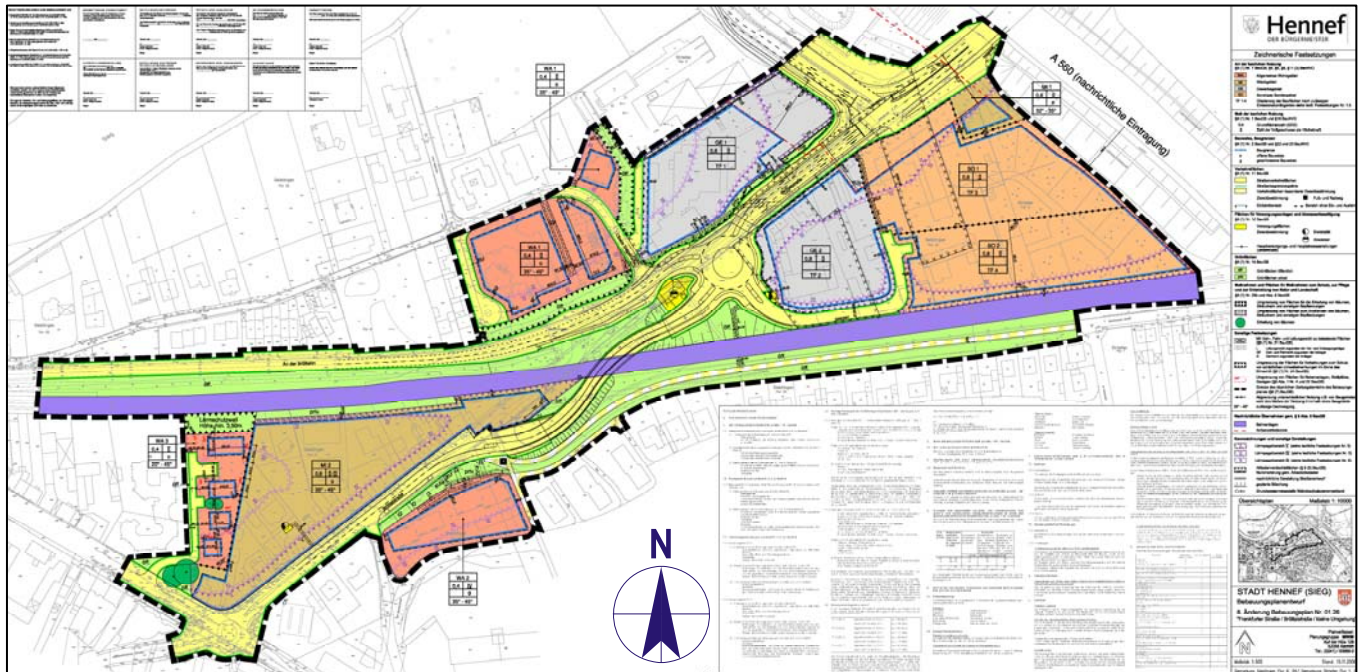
Bebauungsplan Nr. 01.26 (8. Änderung) „Frankfurter Straße / Bröltalstraße / kleine Umgehung“ der Stadt Hennef (Stand 15.11.2006)
